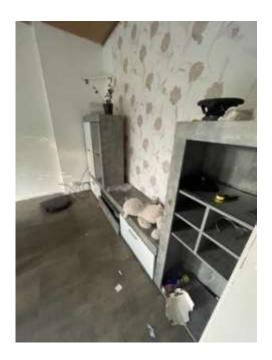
Ansicht Wohnung Roonstraße 69 2.0G links
